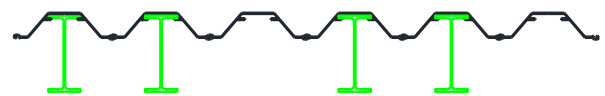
帽型 H 型钢嵌合型组合桩截面图(插二跳一)
